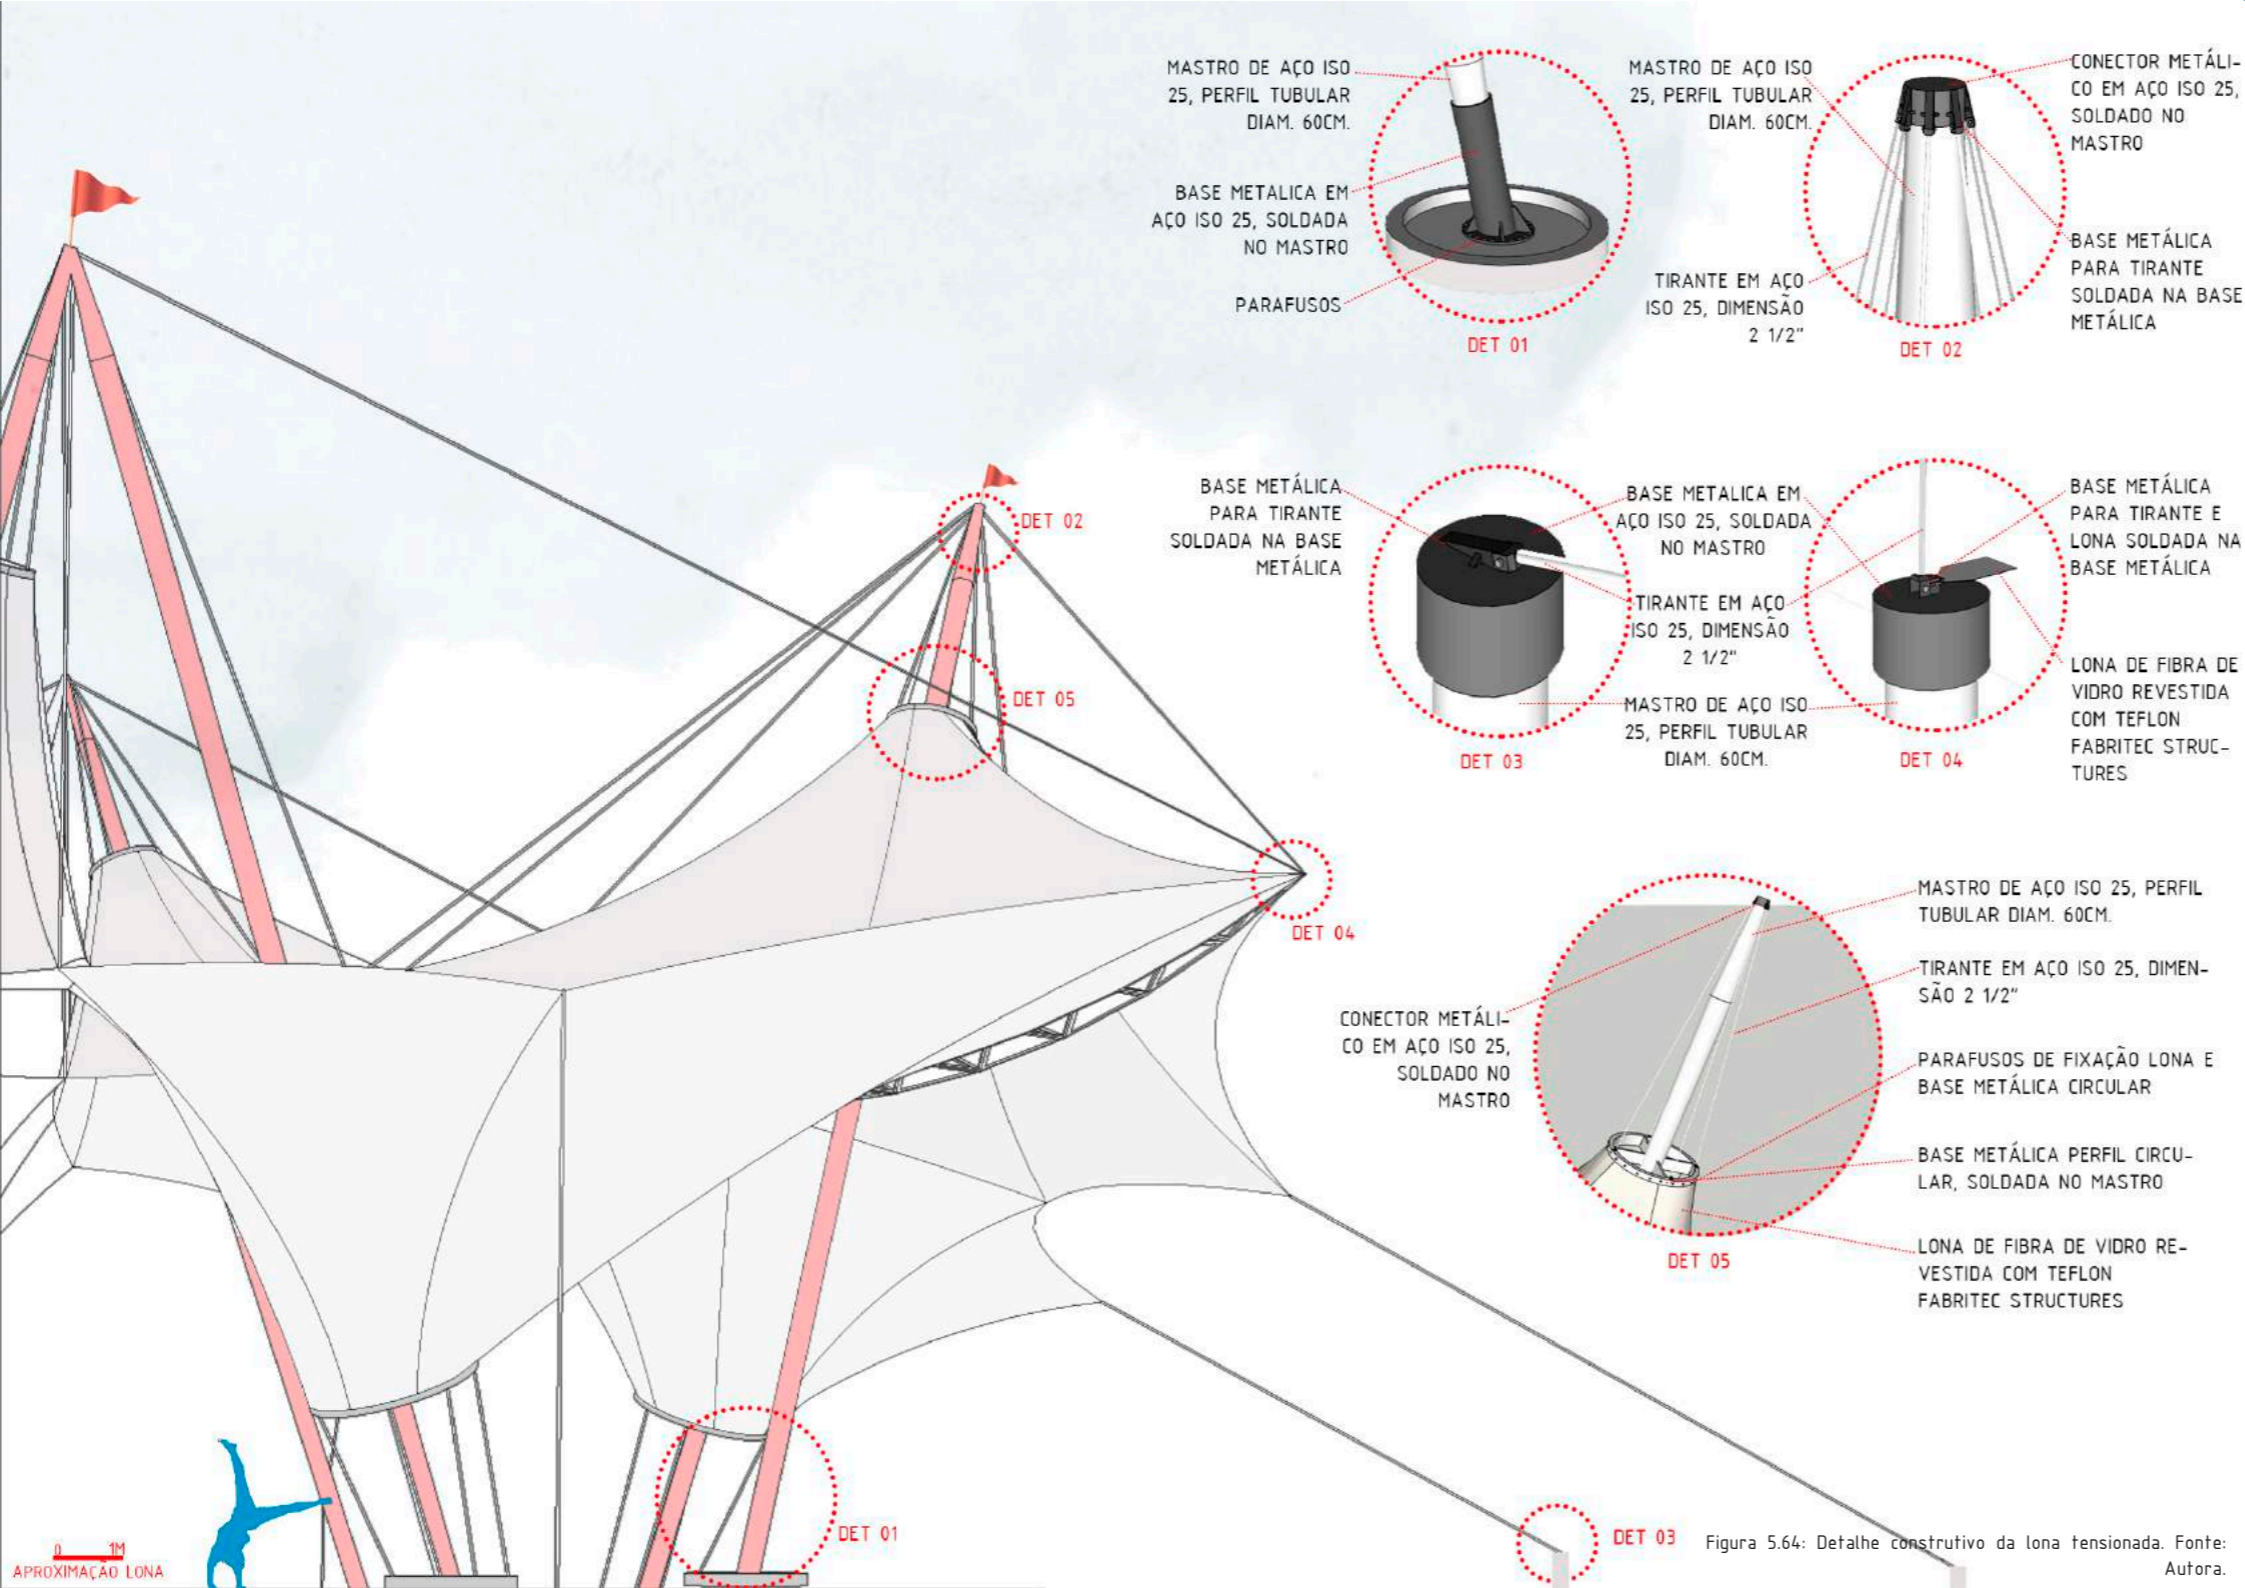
Detalhe construtivo da lona tensionada. Fonte: Autora.
